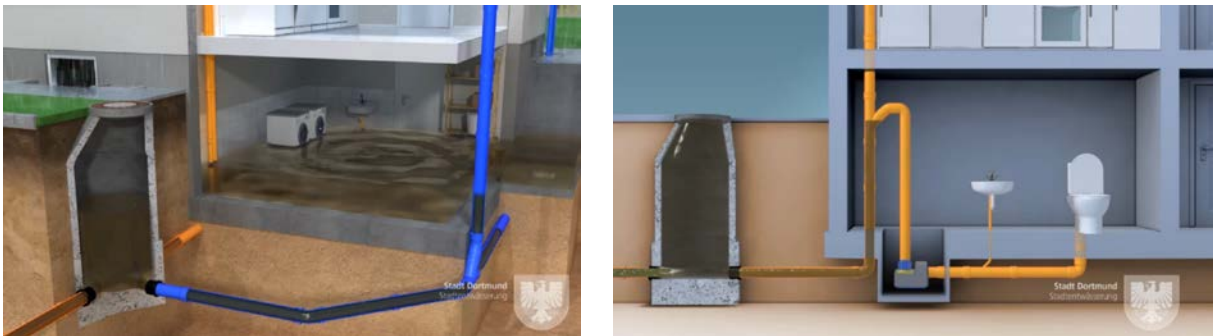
visaplan Film „Rückstausicherheit und Überflutungsschutz“, Bildeindrücke [Stadt Dortmund - Stadtentwässerung]
